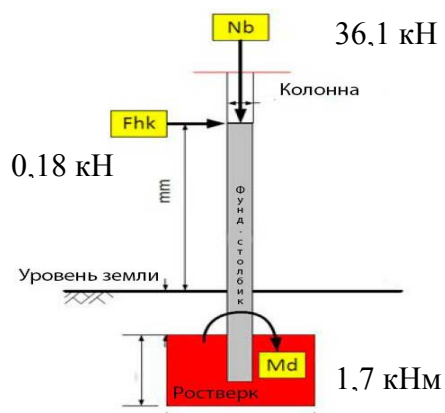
Схема расчетных нагрузок на колонну каркаса блока теплиц
